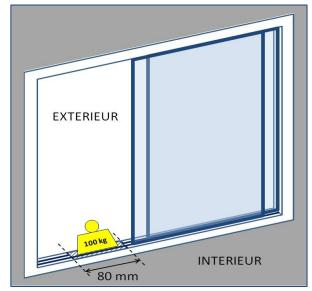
Application d'une charge additionnelle de 100 daN sur une largeur de 80 mm (feuillure et joue de feuillure) pour test de déformation de la traverse basse d'un coulissant
